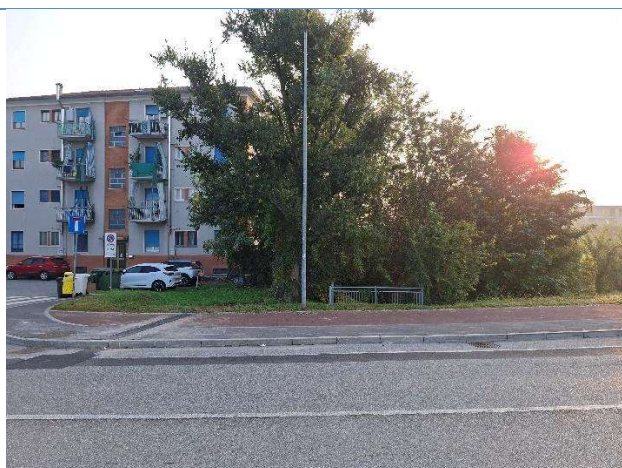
a sx vista imbocco attraversamento via Jannacci; a dx sbocco del medesimo attraversamento
